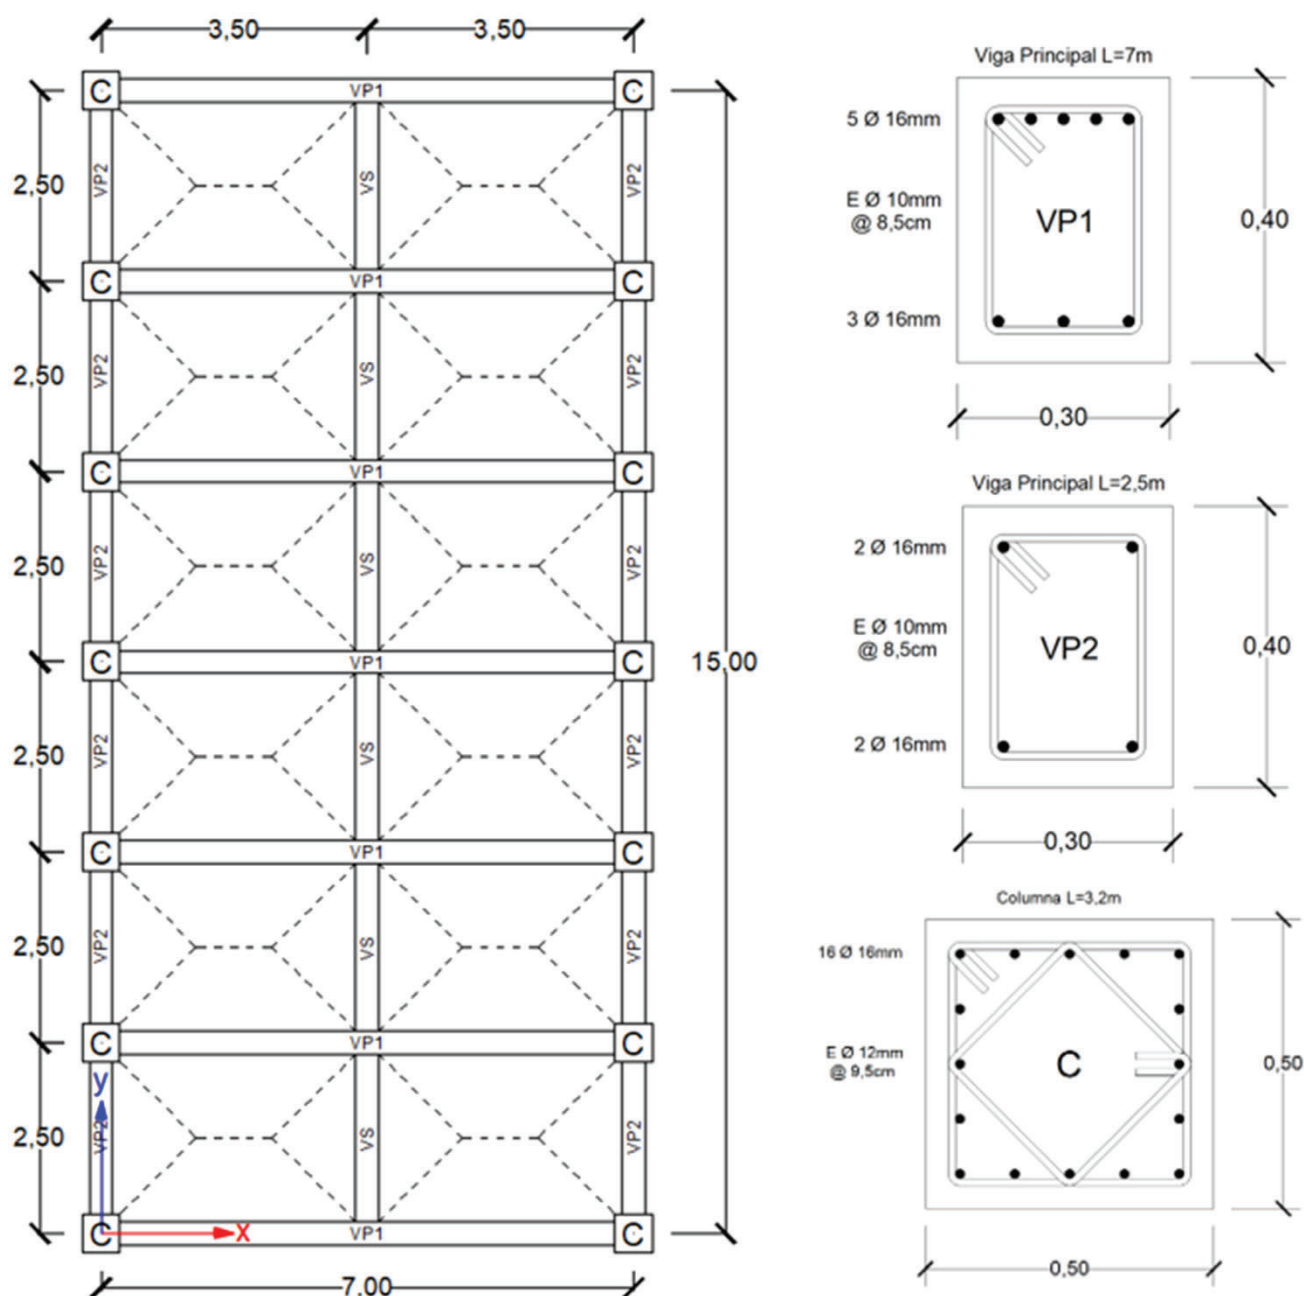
Vista en planta de la vivienda y detalle de las secciones transversales de columnas y vigas principales
